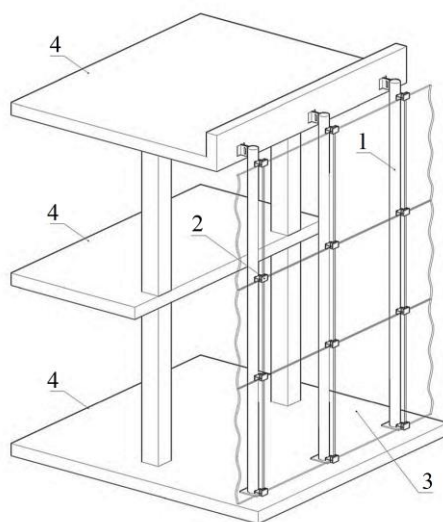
Схема модульной фасадной системы: 1 – каркас панели; 2 – перекрытие; 3 – крепежный элемент; 4 – заполнение панели
